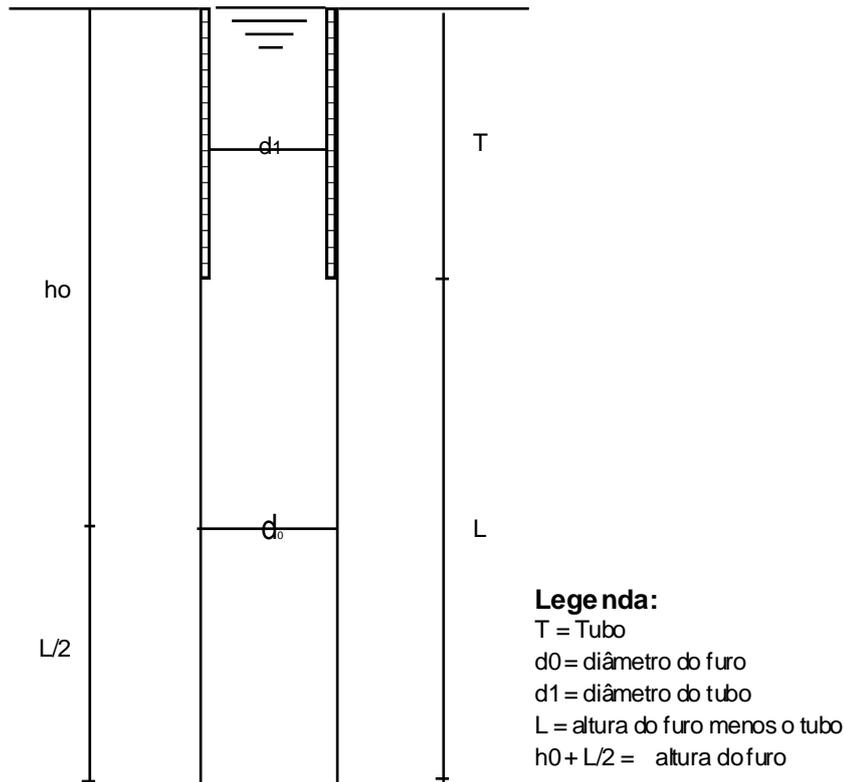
Ensaio de rebaixamento para cálculo da condutividade hidráulica na zona não saturada (ABGE, 1996).
